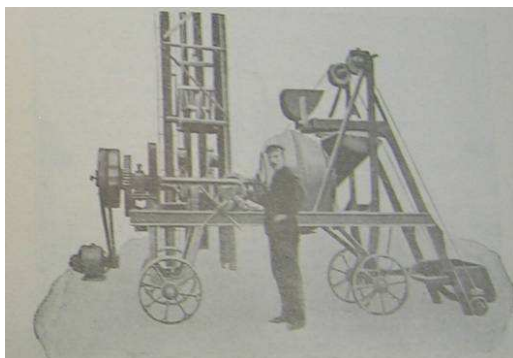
Hormigonera Roll. (Gallego, 1918).
